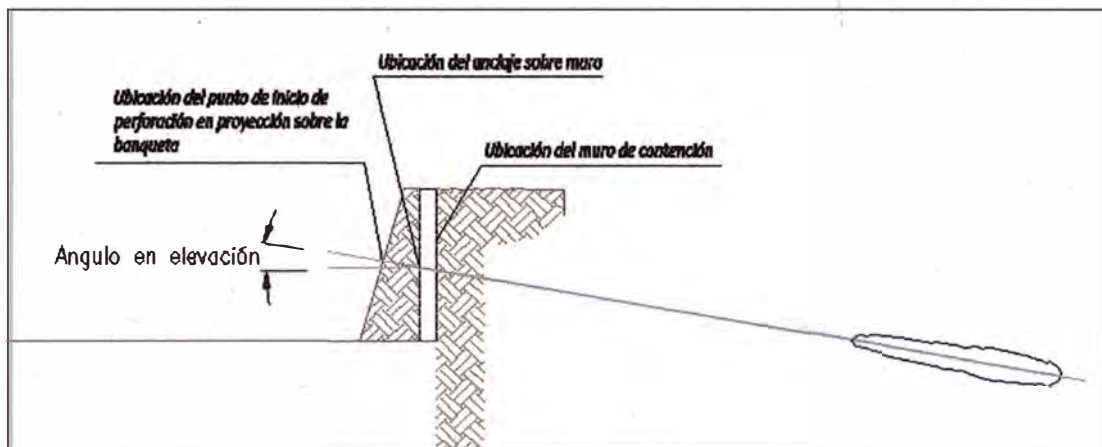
Ángulo en elevación del anclaje sobre la banqueta
